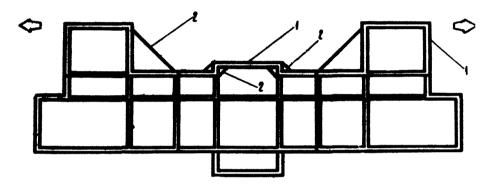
Схема устройства днагональных связей-распорок между обвязочными балками для защиты здания от скашивания основния:
